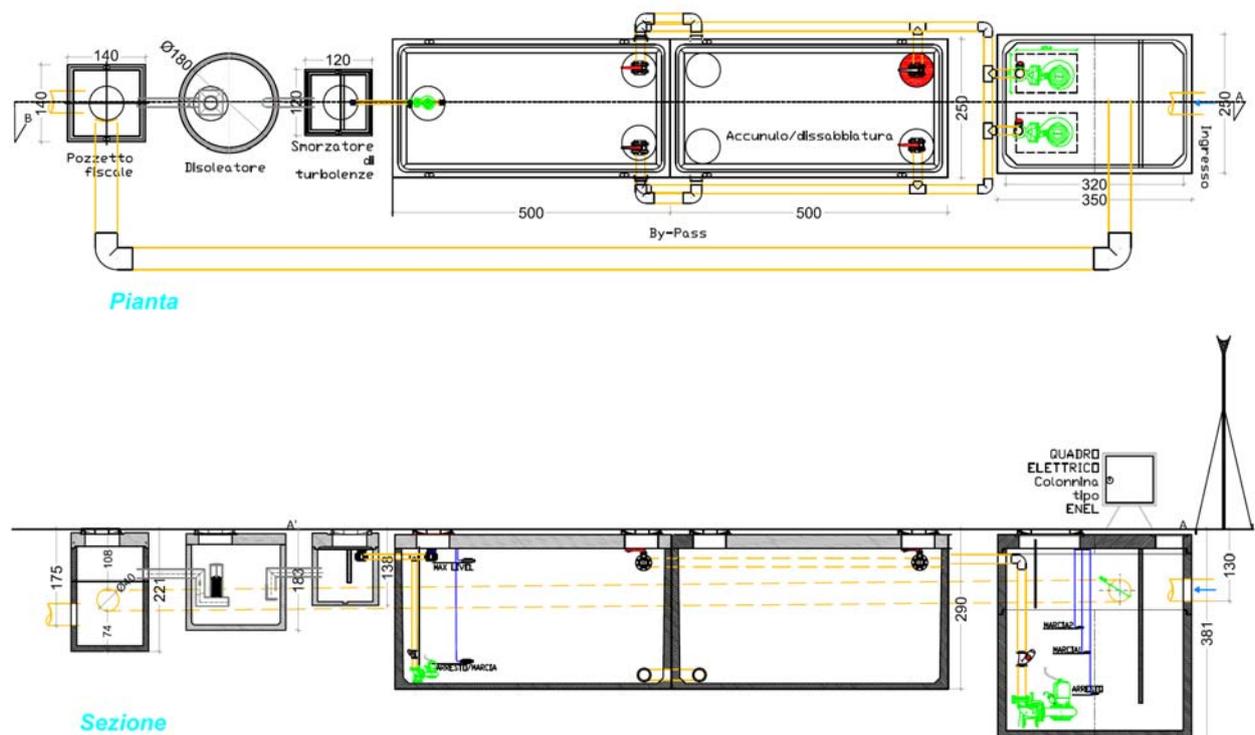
Pianta e sezione impianto trattamento oli.
